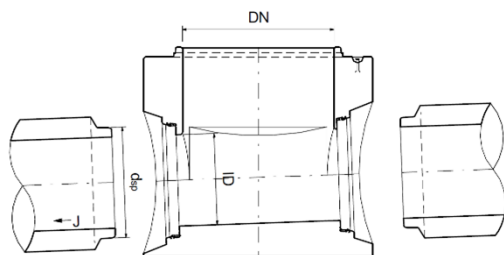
Anschluss mit ROBUST® Röser Stahlbetonrohre mit Gefälle J ≤ 150 ‰
